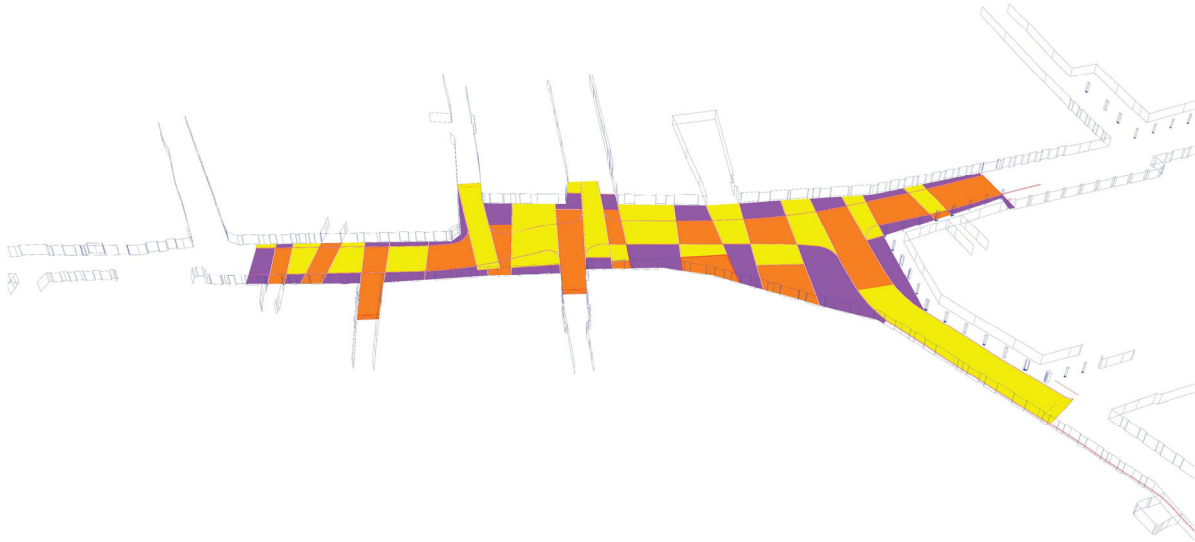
Concept di progetto: evidenziazione delle diverse pavimentazioni tese a sottolineare la composizione nord-sud a scapito dell'attraversamento carraio est-ovest – Fonte: Elaborazione Piani e progetti architetti, Milano
